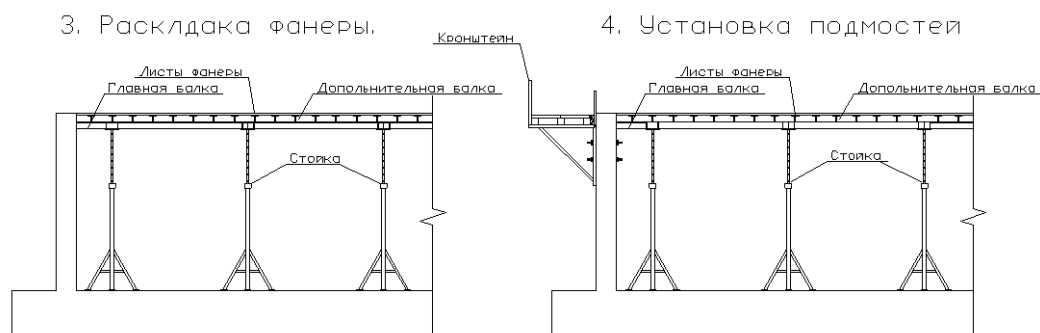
Технологическая схема опалубки плиты перекрытия.
